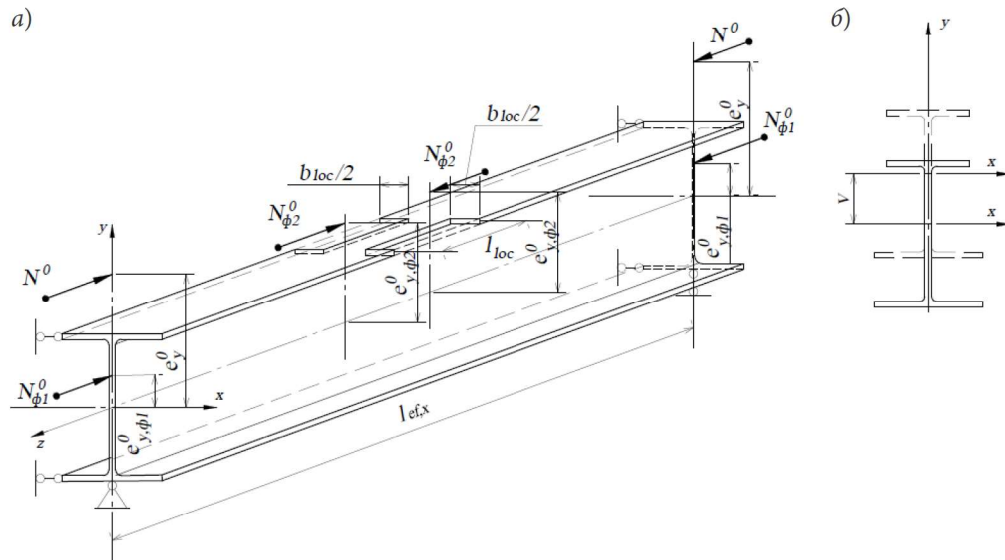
Расчетная модель стержня: а — схема нагружения; б — схема деформирования
